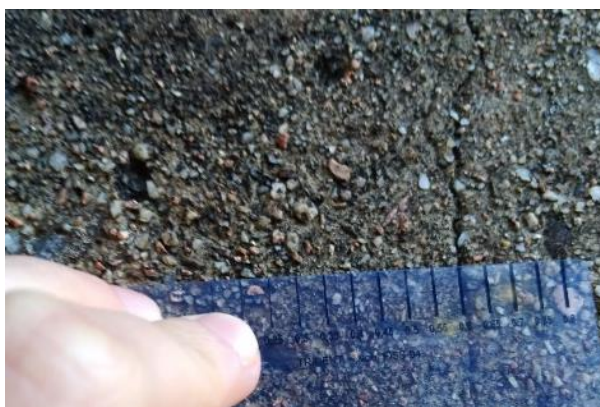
Bloco do vertedouro – Fissura com abertura de 0,6mm.
